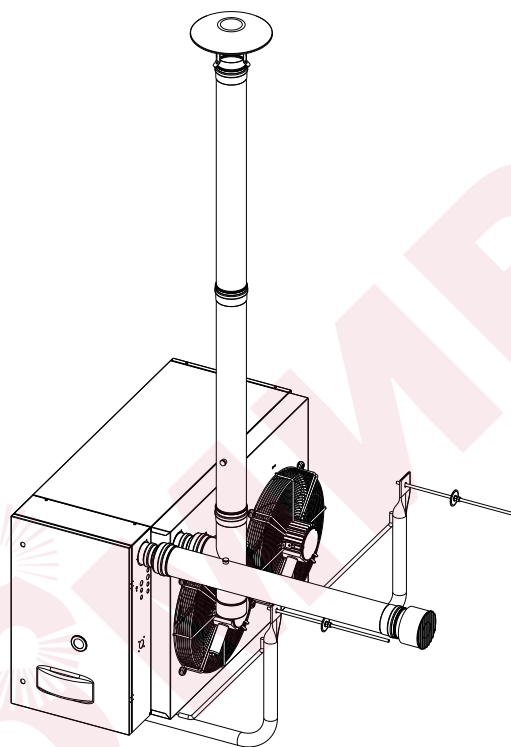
Установка типа C53 с трубами Ø 110.
